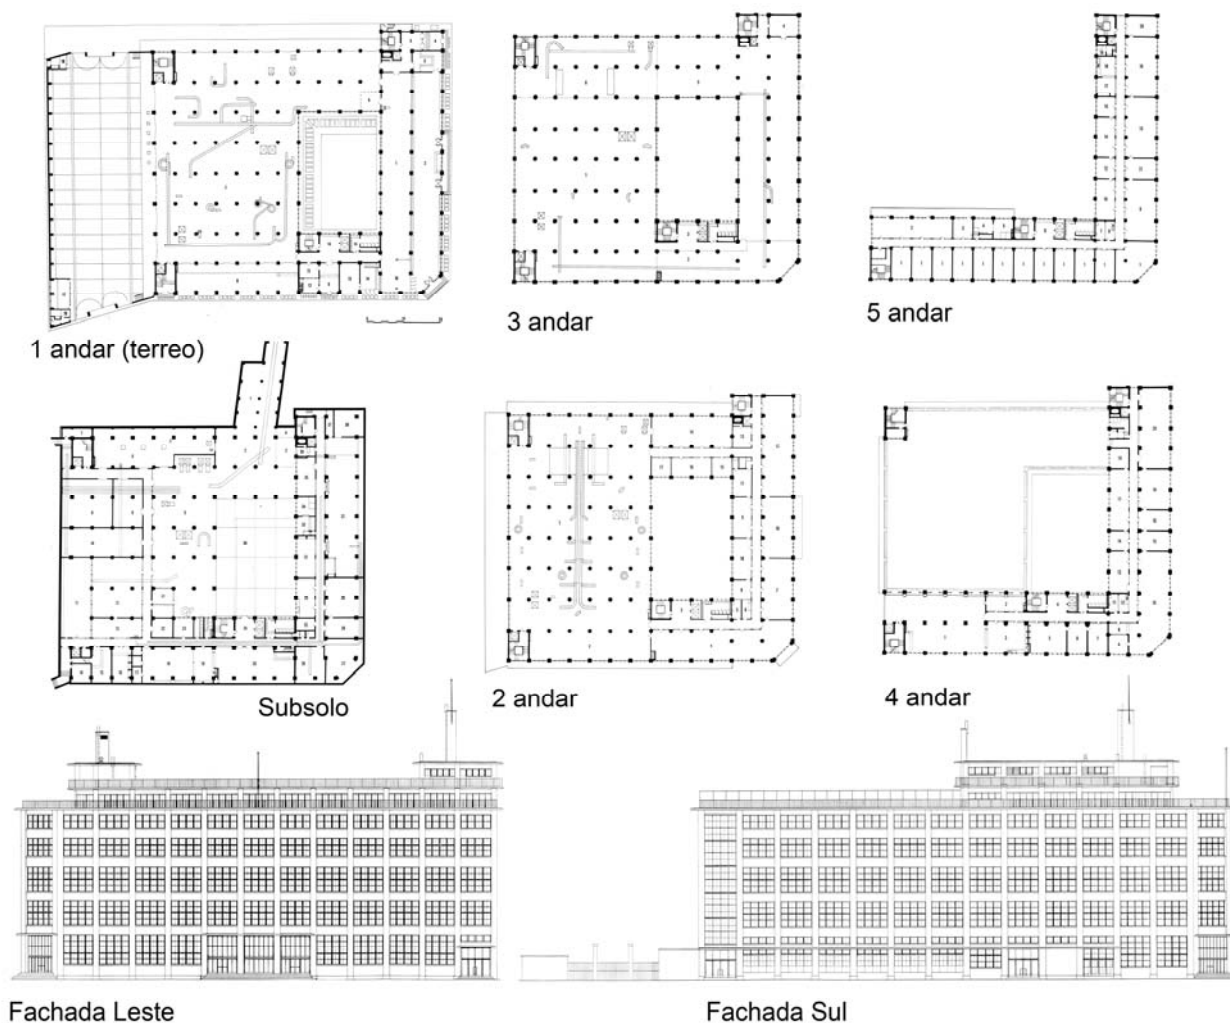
plantas e fachadas da estação central de Osaka [Yoshida T. , 1933]
